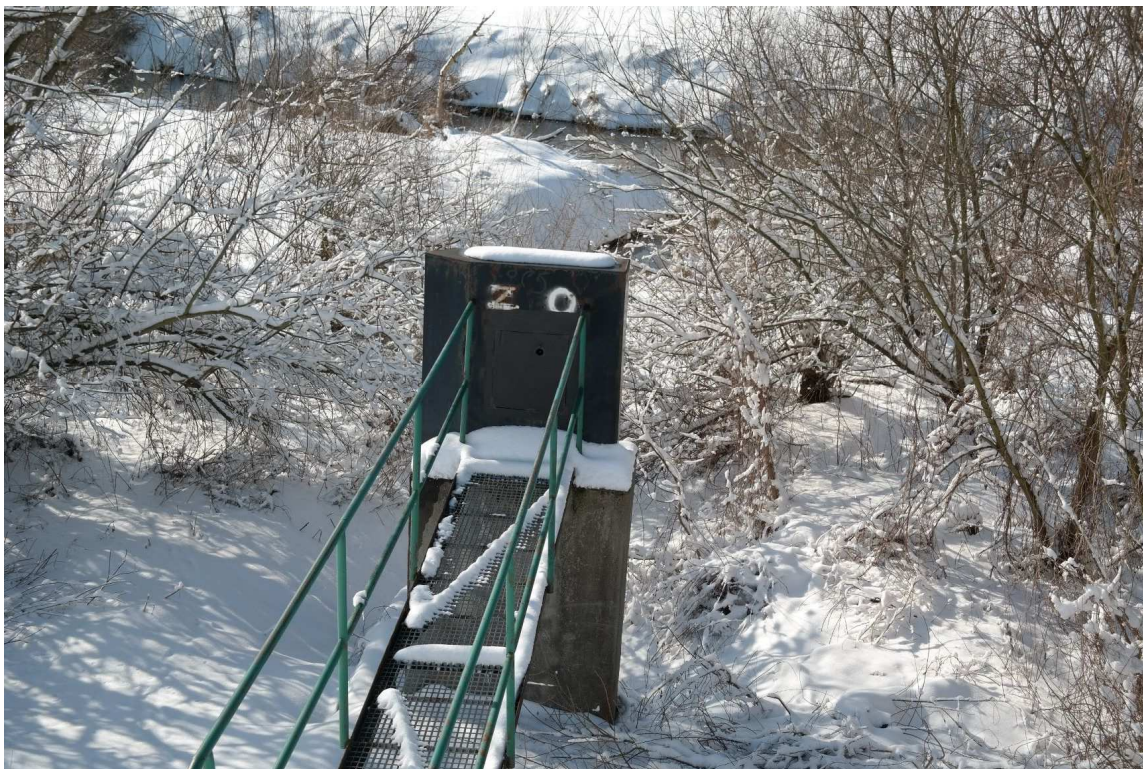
Widok od strony wału przeciwpowodziowego. Konstrukcja przepustu w km 1+445 oraz 0+446 Prawego Wału rzeki Osy.
